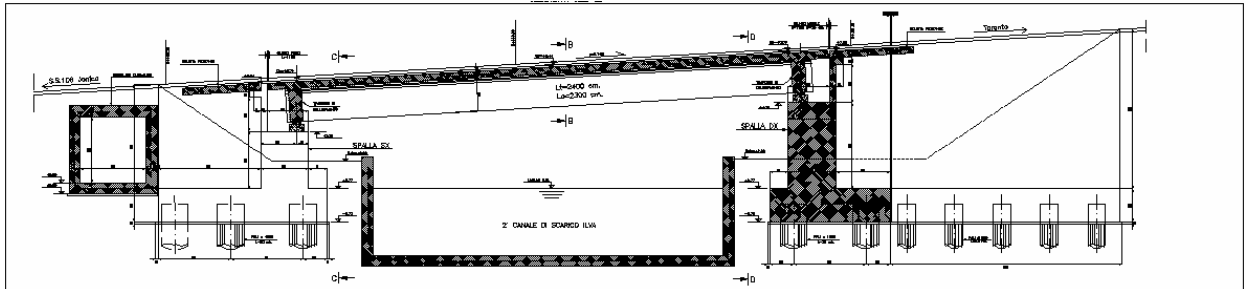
Profilo longitudinale d'insieme del ponte
